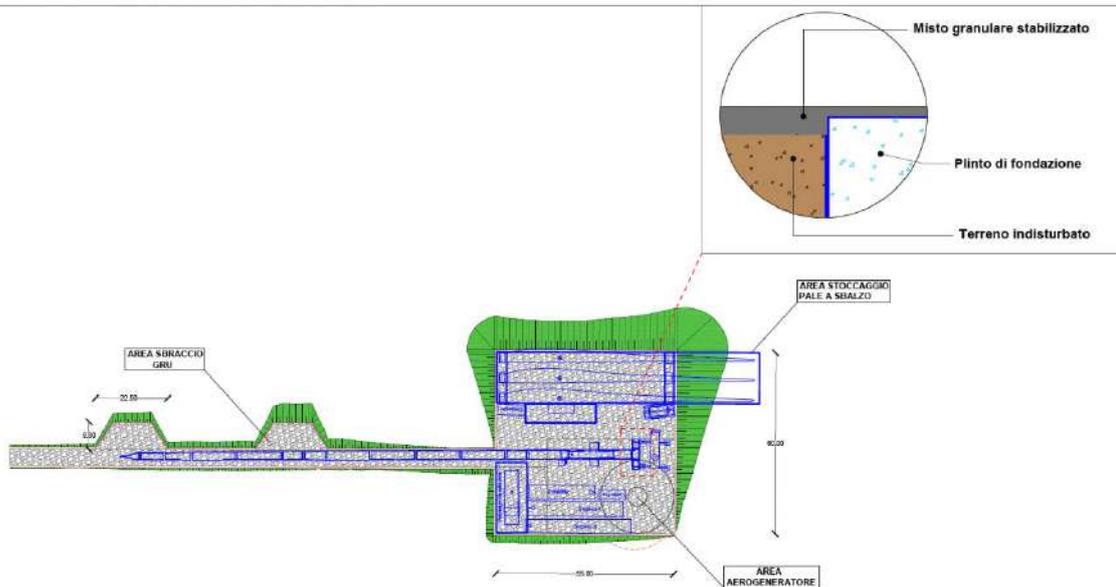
Planimetria piazzola tipo in fase di esecuzione lavori
